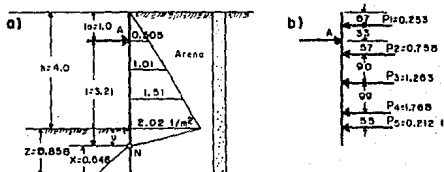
Tablестacado anclado y sin empotramiento en el terreno
